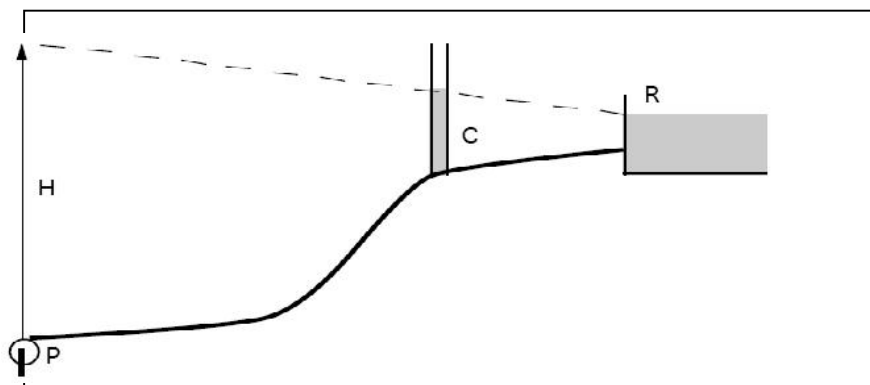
Cheminée d'équilibre sur une conduite de refoulement
